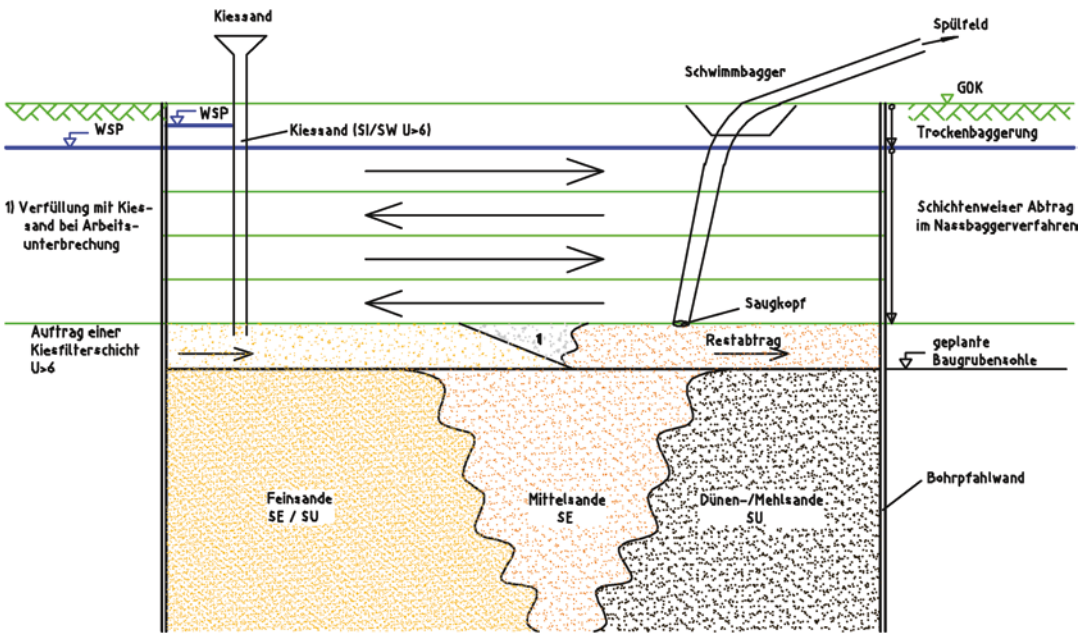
Auflockerung bei längerer Standzeit in der Baugrubensohle, z. B. bei Verzögerung des Betonierens der Unterwasserbetonsohle (UWBS)
